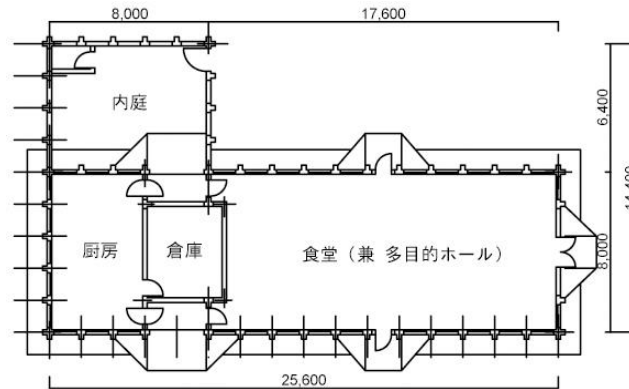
厨房・食堂（兼多目的ホール）棟 平面図
